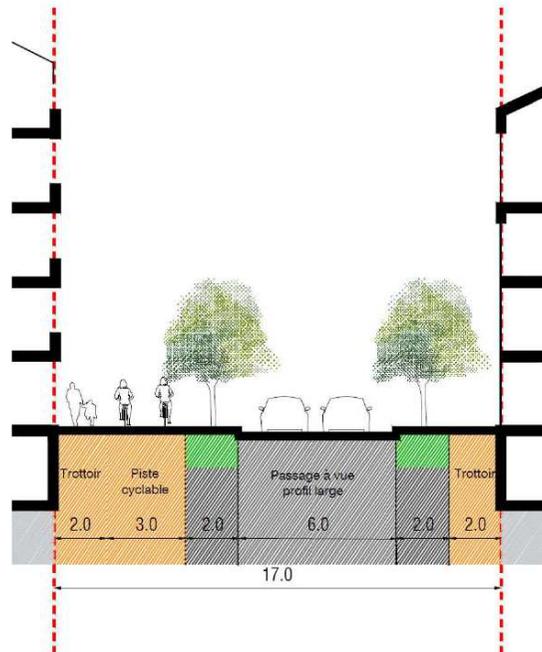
Coupe de principe sur la voie centrale – gabarit 17 m
